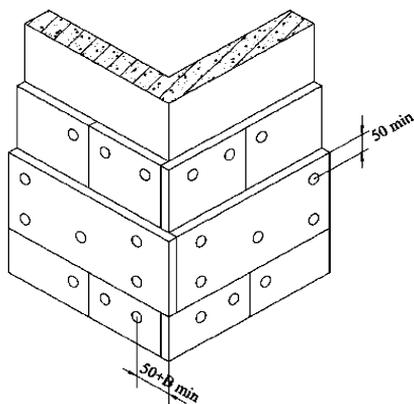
Схема крепления двухслойного утеплителя на углу здания (B min – наименьшая толщина минераловатной плиты)
